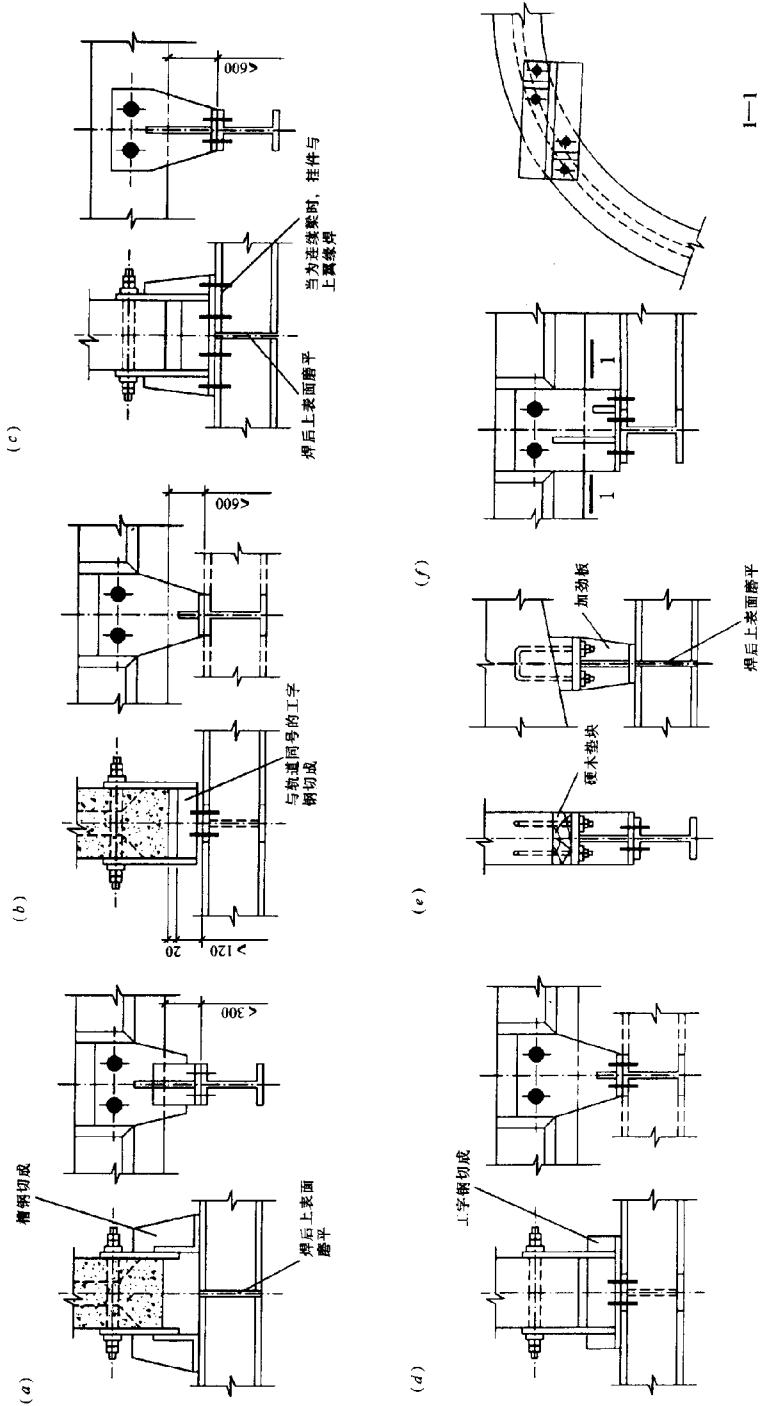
悬挂吊车梁与钢筋混凝土的连接
